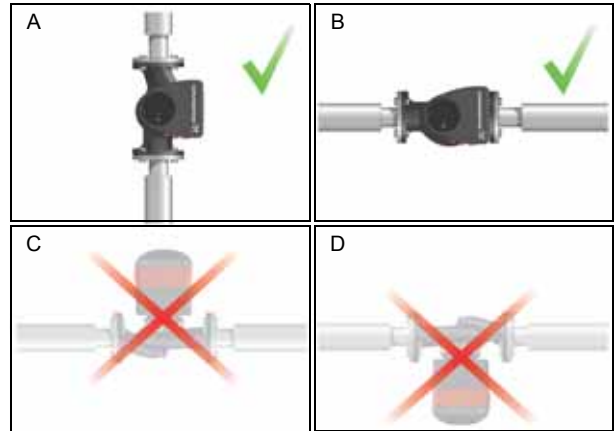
Bomba instalada con el eje del motor en posición horizontal
